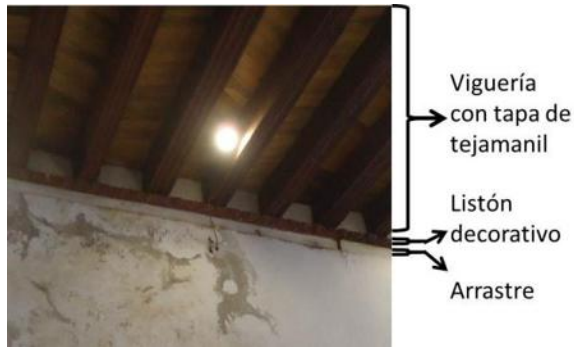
Sistema de cubierta formado por vigería con tapa de tejamanil (nave) - elaborado en Marzo de 2012 por Anyul Cuéllar
